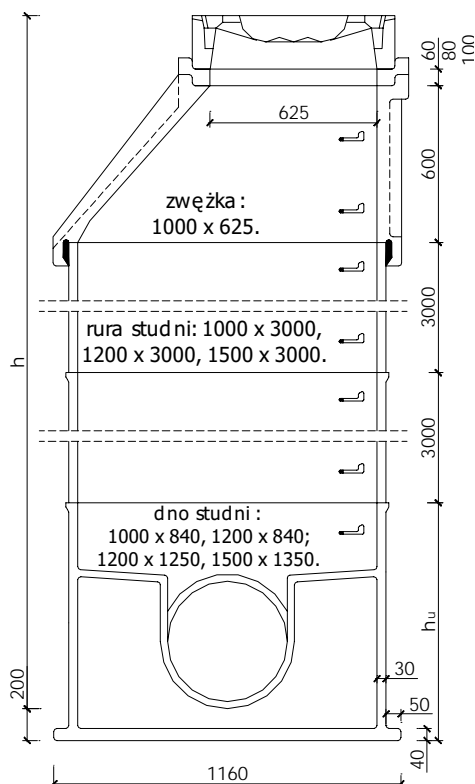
Żelbetowa komora połączeniowa wykonana przez firmę Steinrisse
